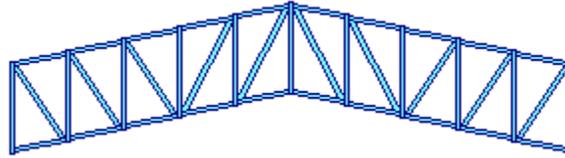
Armadura Pratt-Howe, 10 Paneles.
